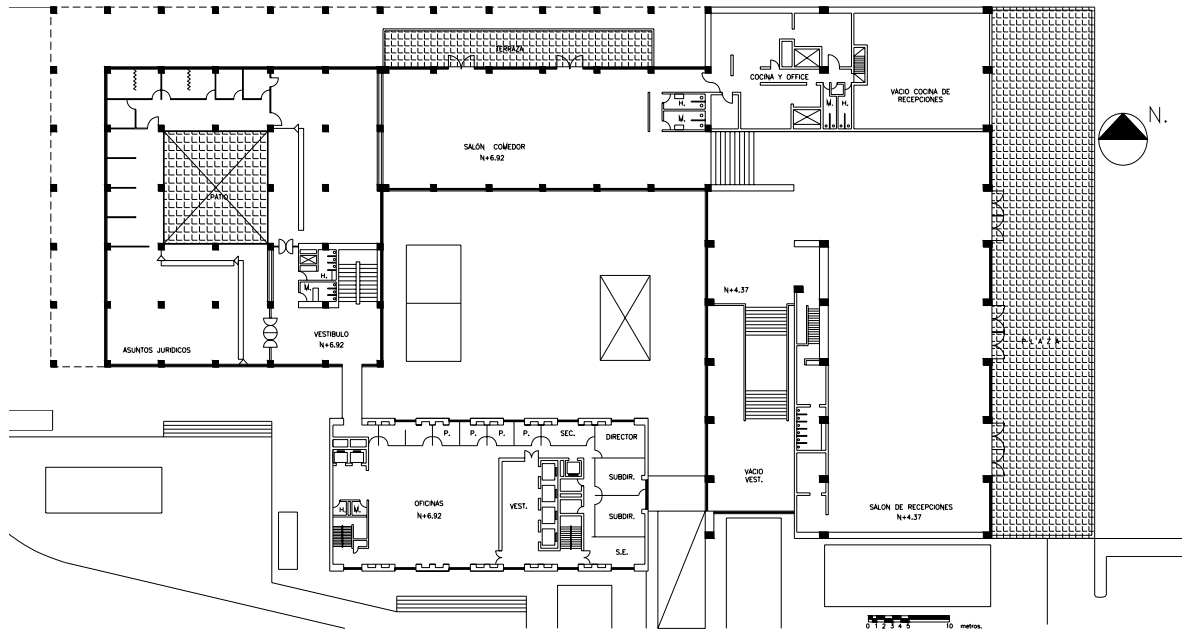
Planta del primer piso (N+4.23 m y N+6.84 m)
